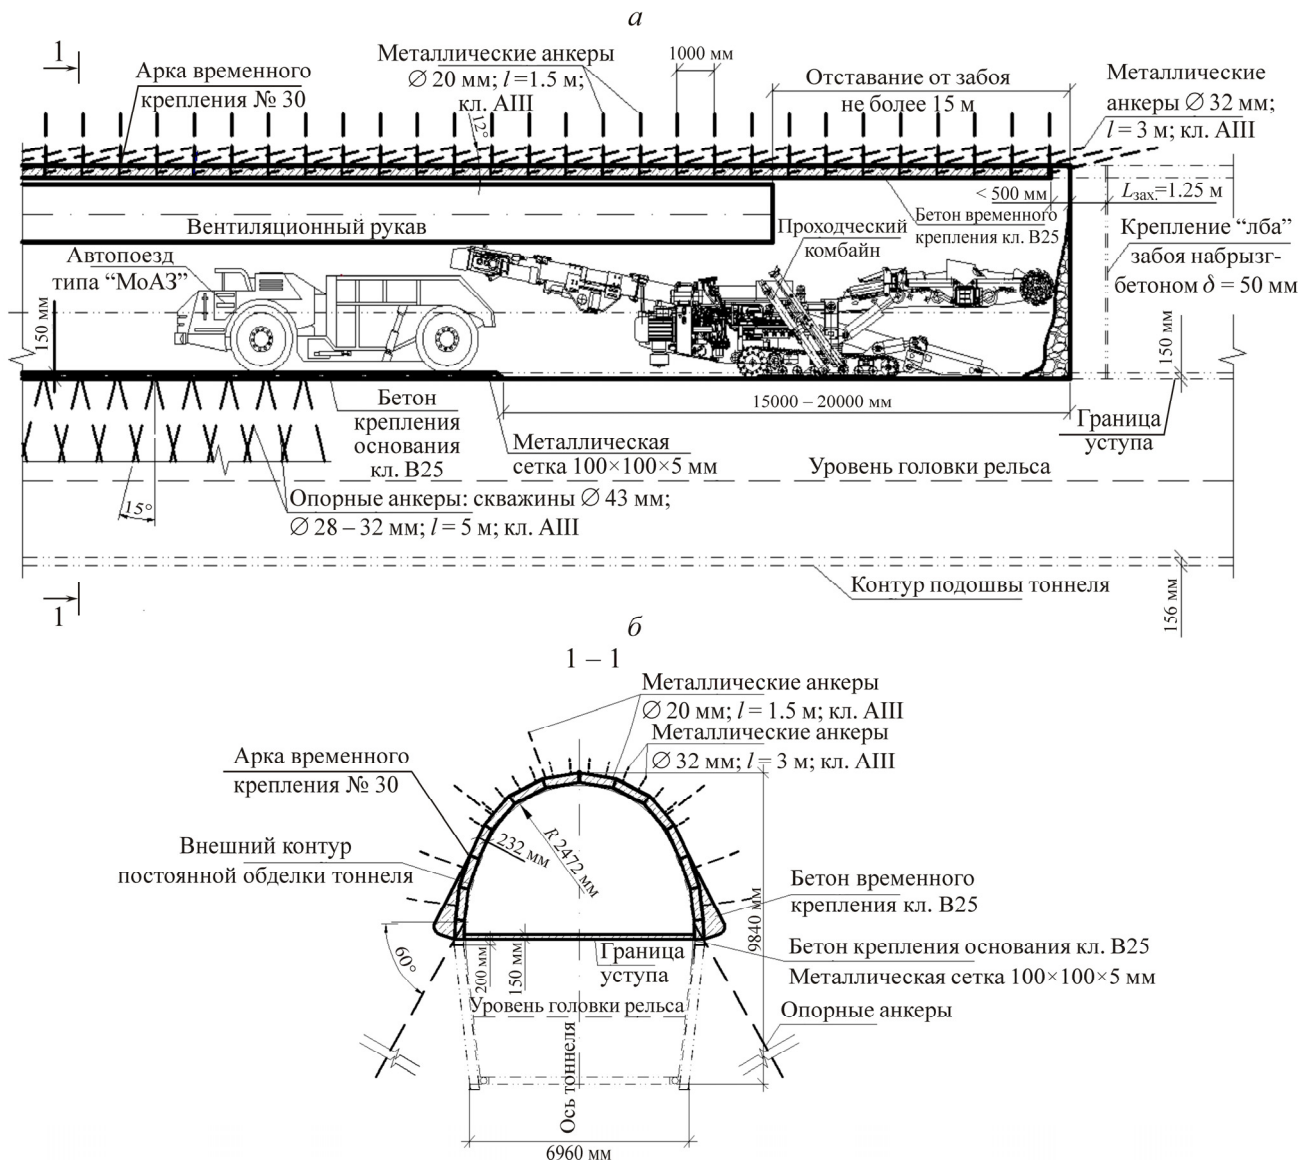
Продольный разрез выработки по трассе тоннеля со схемой разработки калотты проходческим комбайном и подъездом автопоезда для выгрузки забоя (а); поперечный разрез выработки с определением зоны сопряжения калотты и штроссы, дополнительно закрепляемой бетоном для стабилизации пород по внешнему контуру временной крепи (б)
